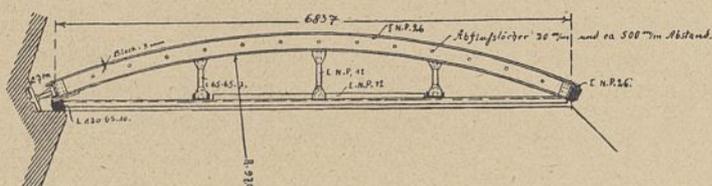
Stemmtor, Schnitt E-F. M. 1:100.
